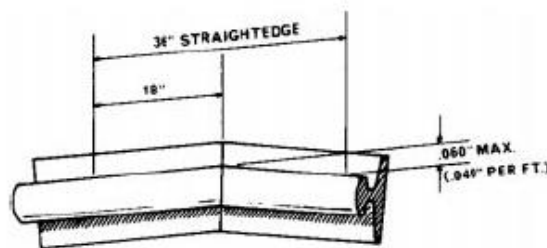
Tolerância dimensional para desalinhamento horizontal de trilhos soldados por centelhamento
